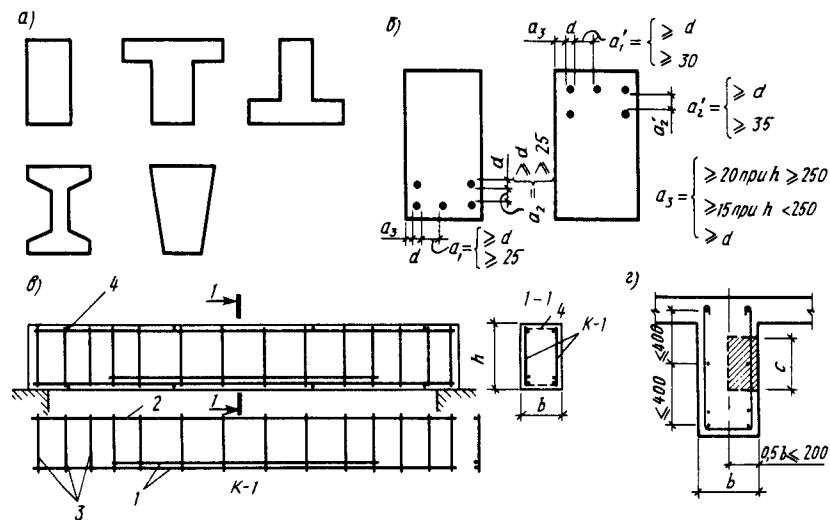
Формы поперечного сечения и армирование железобетонных балок: а — возможные формы сечения; б — размещение продольной арматуры в сечении; в — армирование однопролетной железобетонной балки; г — к определению площади дополнительной арматуры у боковых граней балок при  $h > 700$  мм; 1 — рабочая арматура; 2 — монтажная арматура; 3 — поперечные стержни; 4 — соединительные стержни
